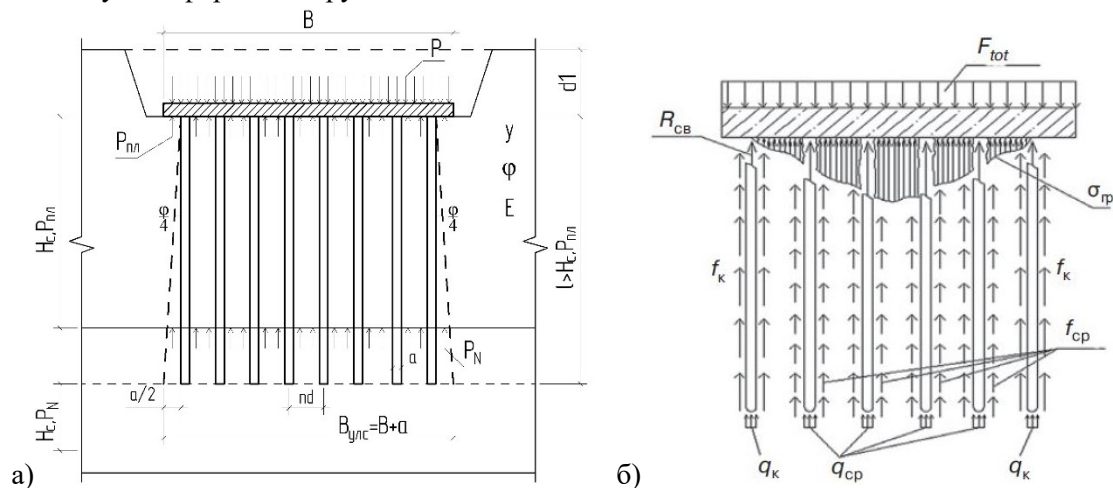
Расчетные схемы: а) Расчетная схема взаимодействия плитно-свайного крупноразмерного фундамента с грунтовым массивом [13]; б) Расчетная схема плитно-свайного фундамента [14];
